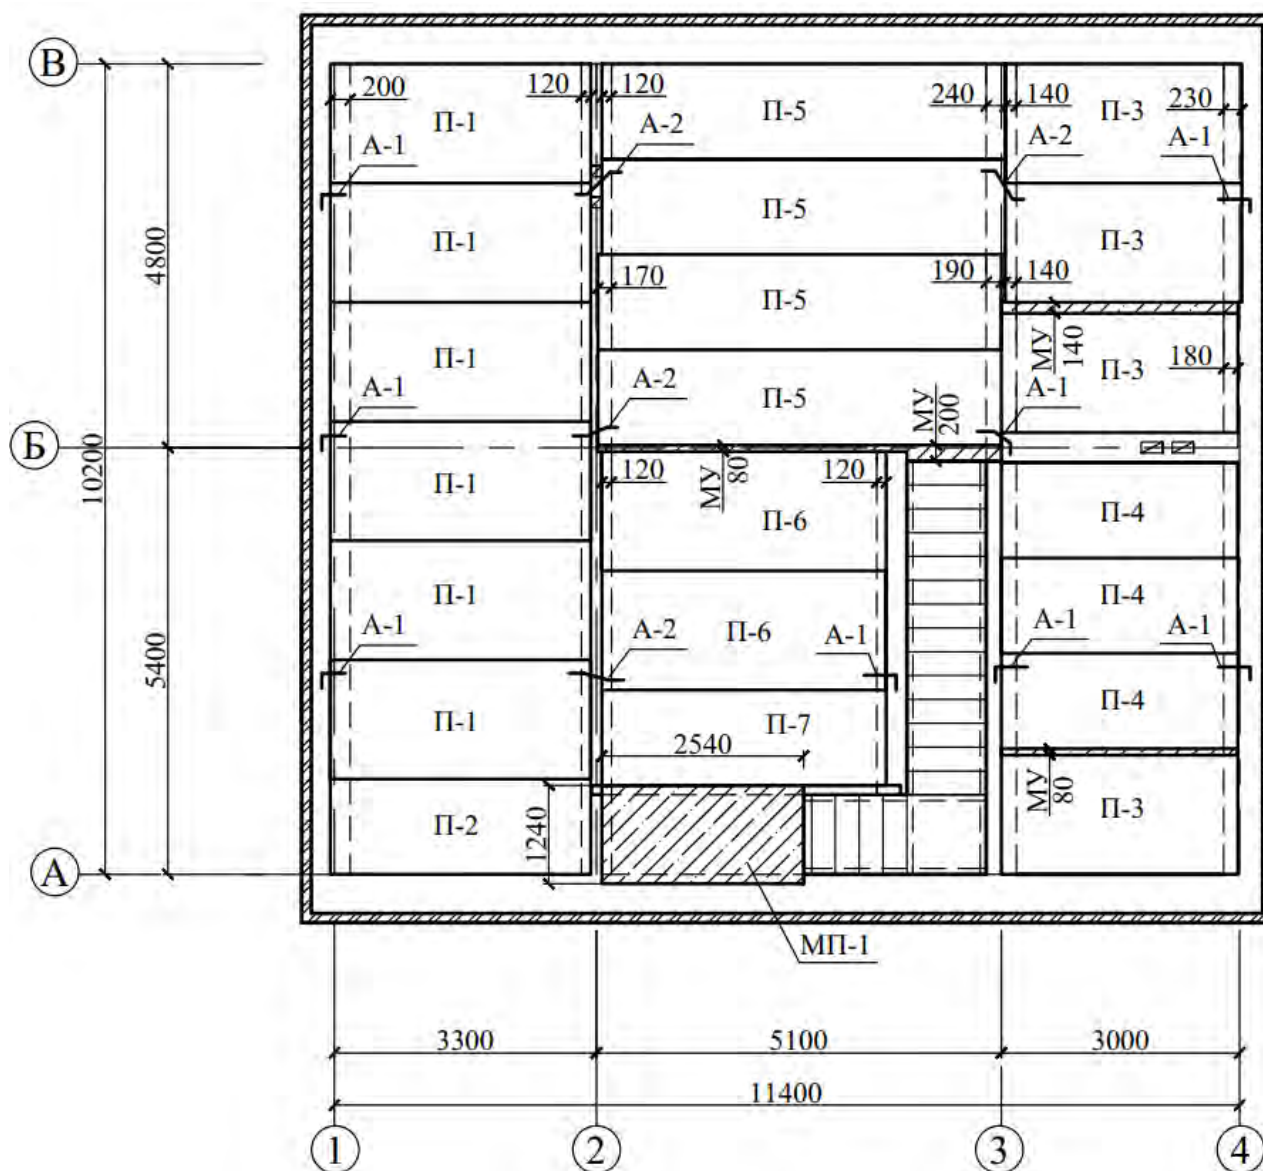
Пример выполнения схемы расположения элементов перекрытия
